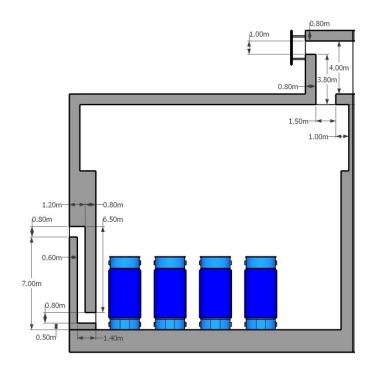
密封鋼筒混凝土貯存窖模組單元示意圖
